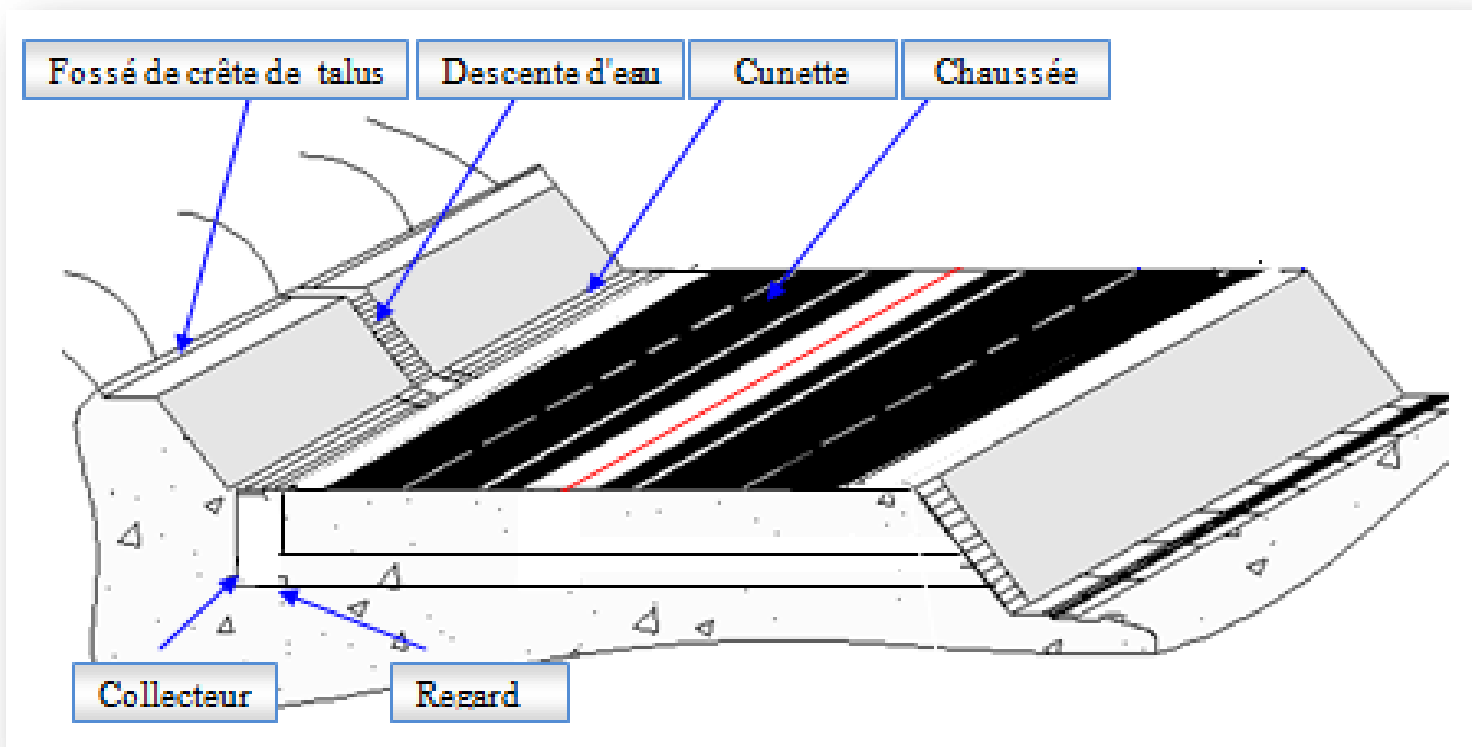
les éléments de l'assainissement de la chaussée routière.
